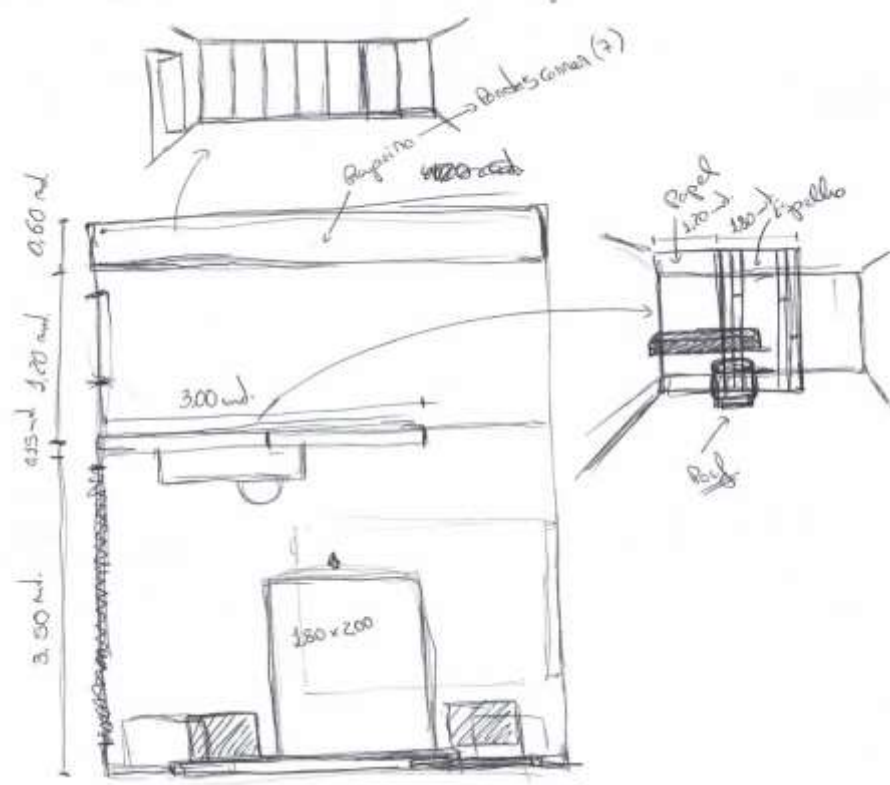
Planta e perspectivas do espaço, desenhadas à mão levantada
